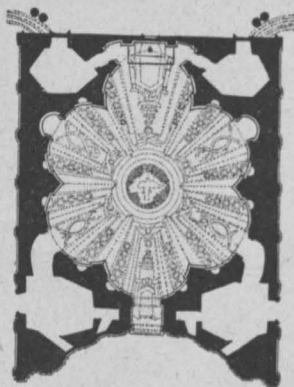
Grundriß von St. Ivo della Sapienza, nach Sandrart.
